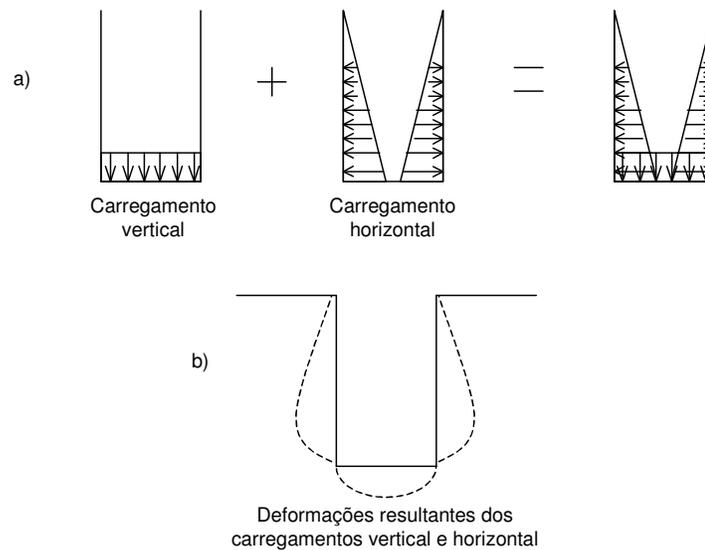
Corte transversal de viga representando esquematicamente: a) cargas verticais e horizontais; b) deformações das fôrmas.
